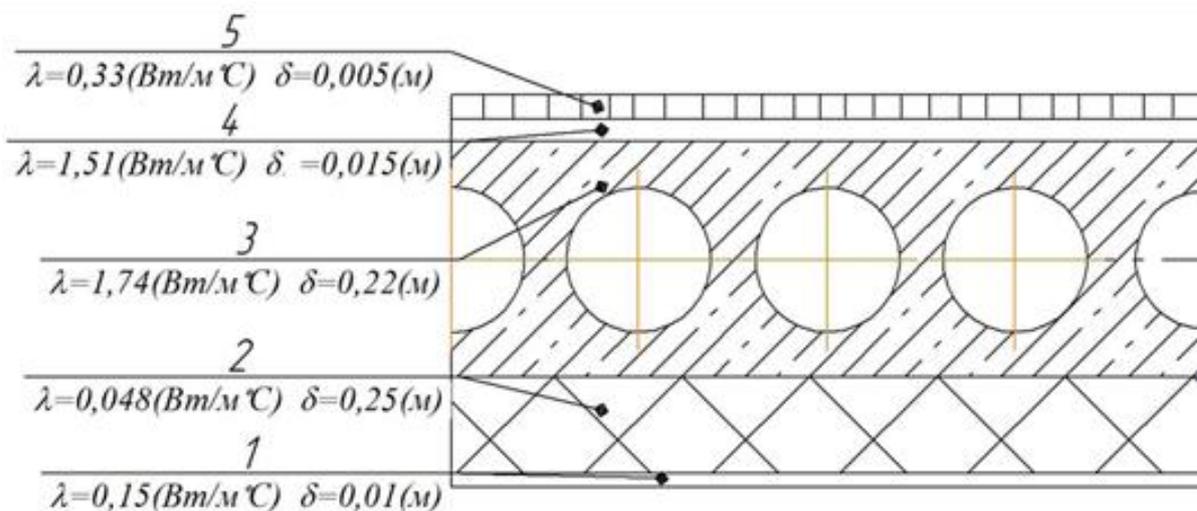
Схема для розрахунку коефіцієнта теплопередачі перекриття над підвалом: 1 – лист гіпсокартону, 2 – пластини мінеральної вати, 3 – залізобетонна плита, 4 – бетонне покриття, 5 – лінолеум
